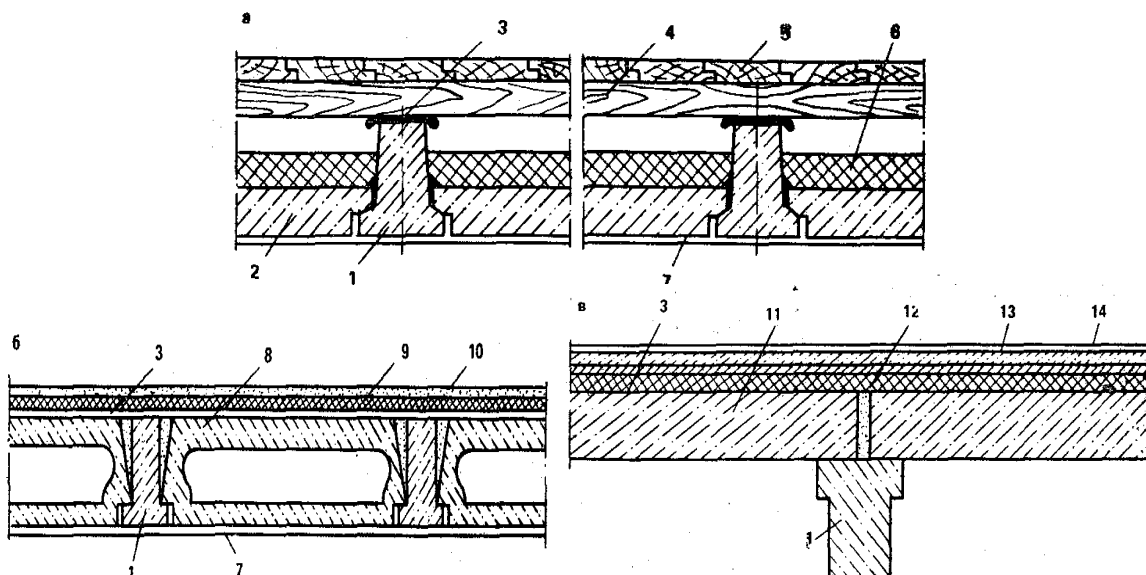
Балочних збірних залізобетонні перекриття
